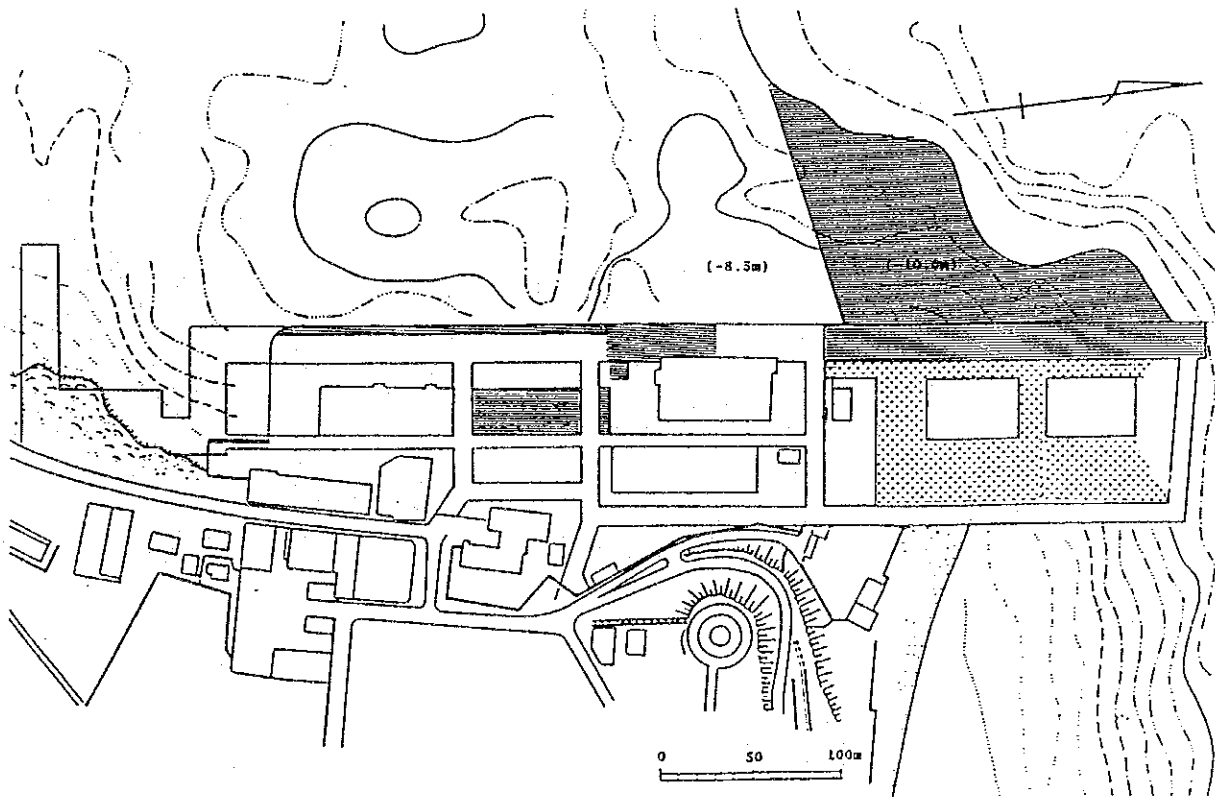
(2) Avancement des Travaux de Construction à la Fin de 1996
